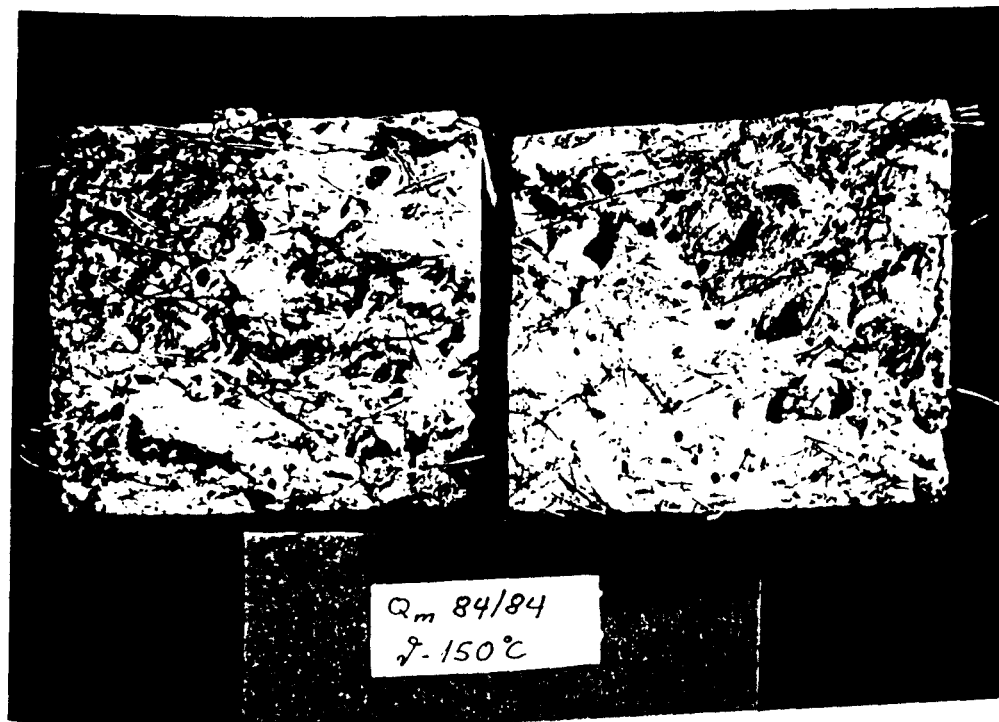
Bruchfläche eines bei 150 °C geprüften, stahlfaserbewehrten Kiesbetonprobekörpers
